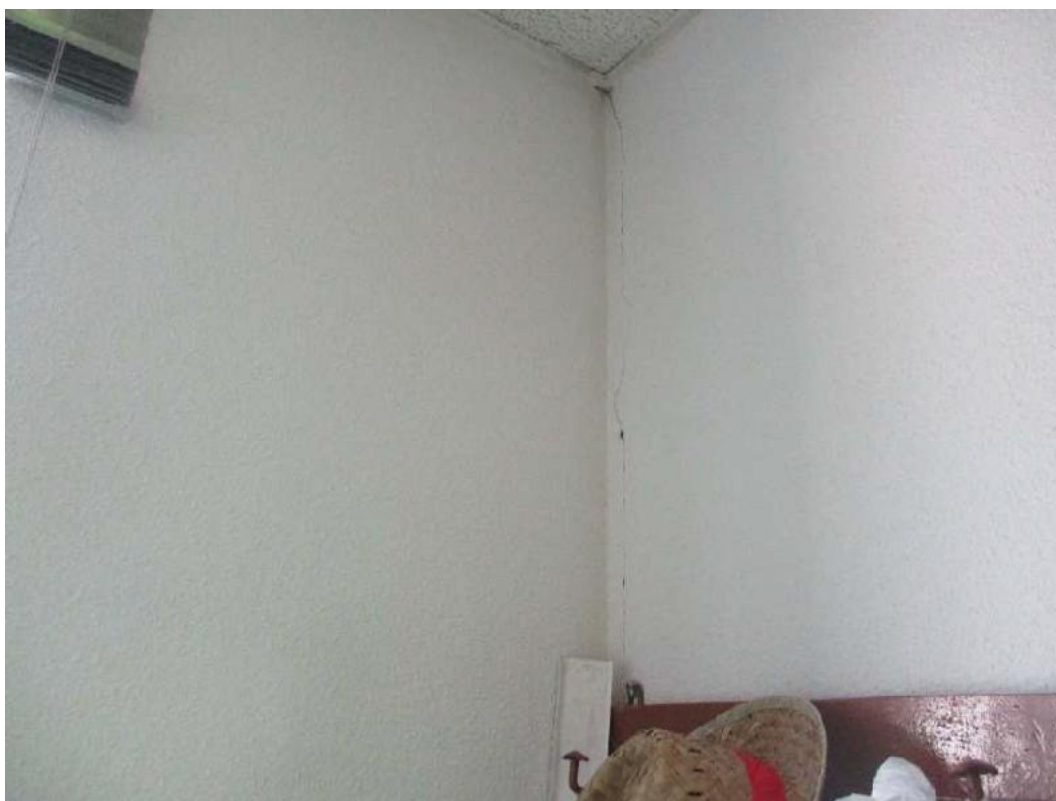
fisura inclinada en la hoja interior del cerramiento de fachada, con signos de reparación previa.
